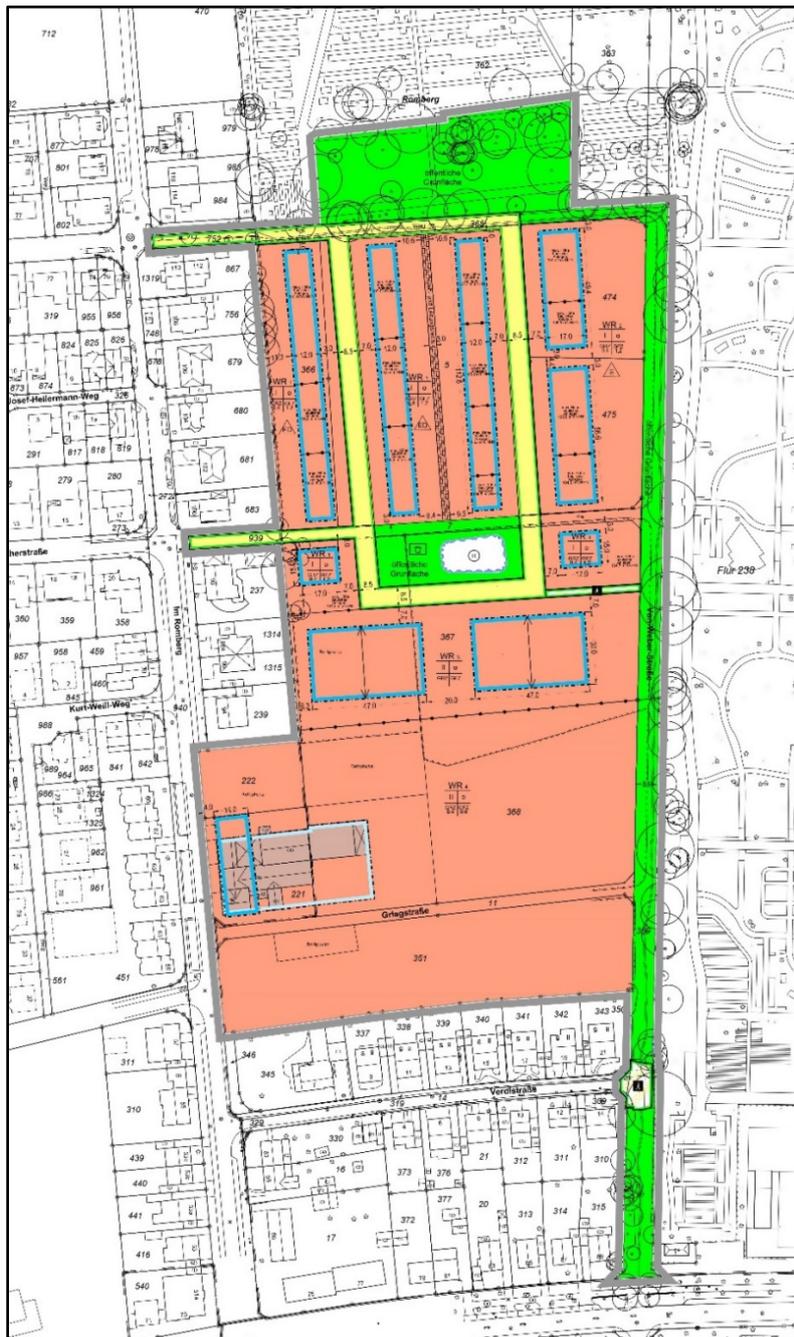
Bebauungsplanentwurf 262 – Griegstraße –
